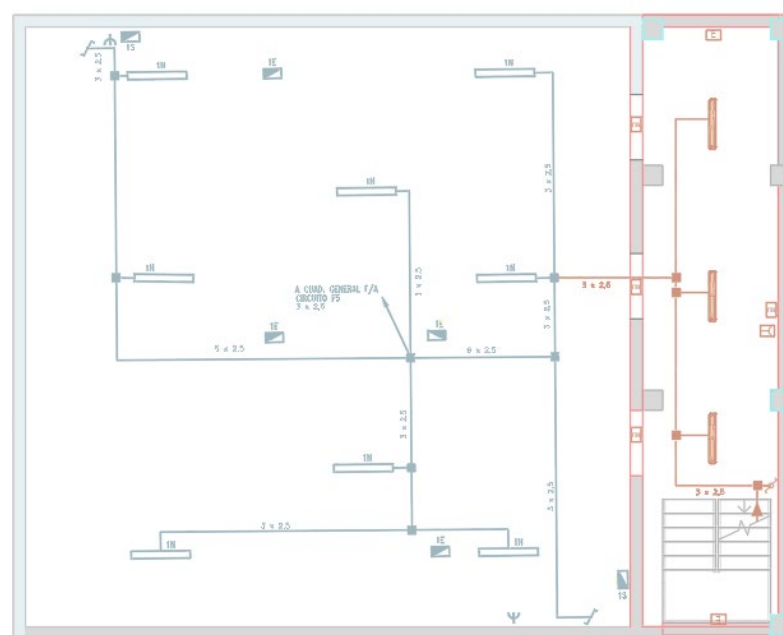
Planta de alumbrado (sótano), existente y de nueva instalación
